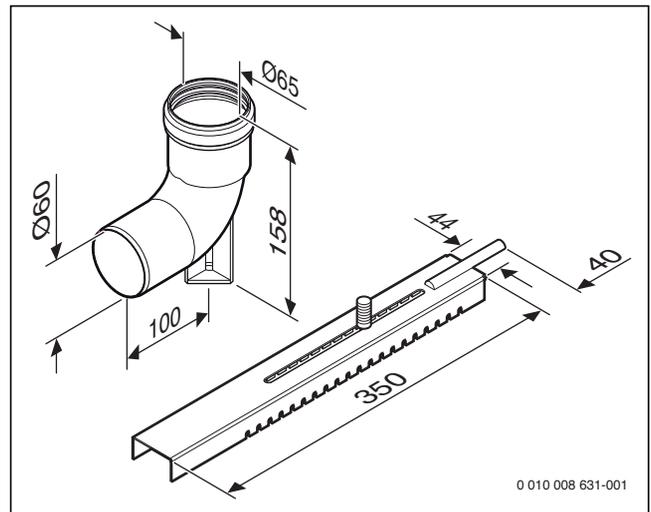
Stützbogen mit Auflageschiene Ø 60 mm (Maße in mm)
